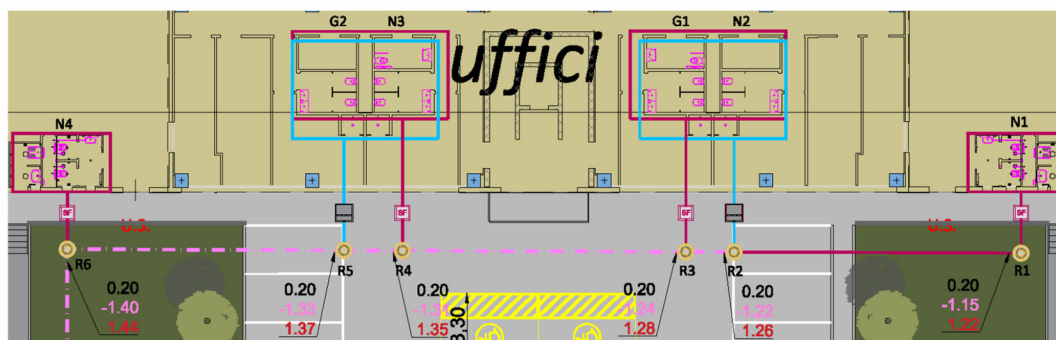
Estratto dall'allegato 04: planimetria della rete di acque reflue con blocchi bagno.
